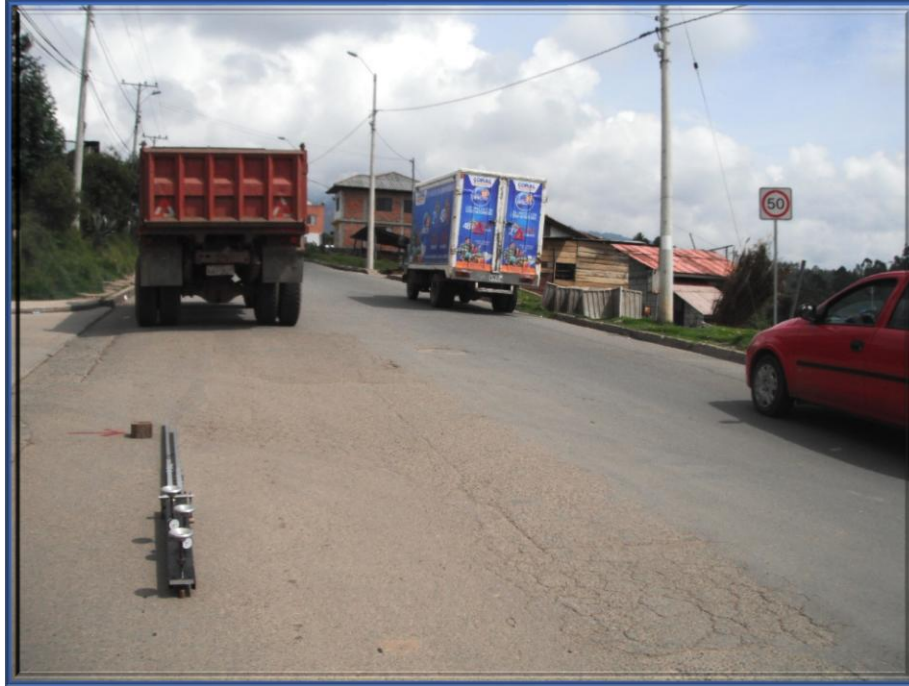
Colocación Típica de la VIGA DE BENKELMAN
